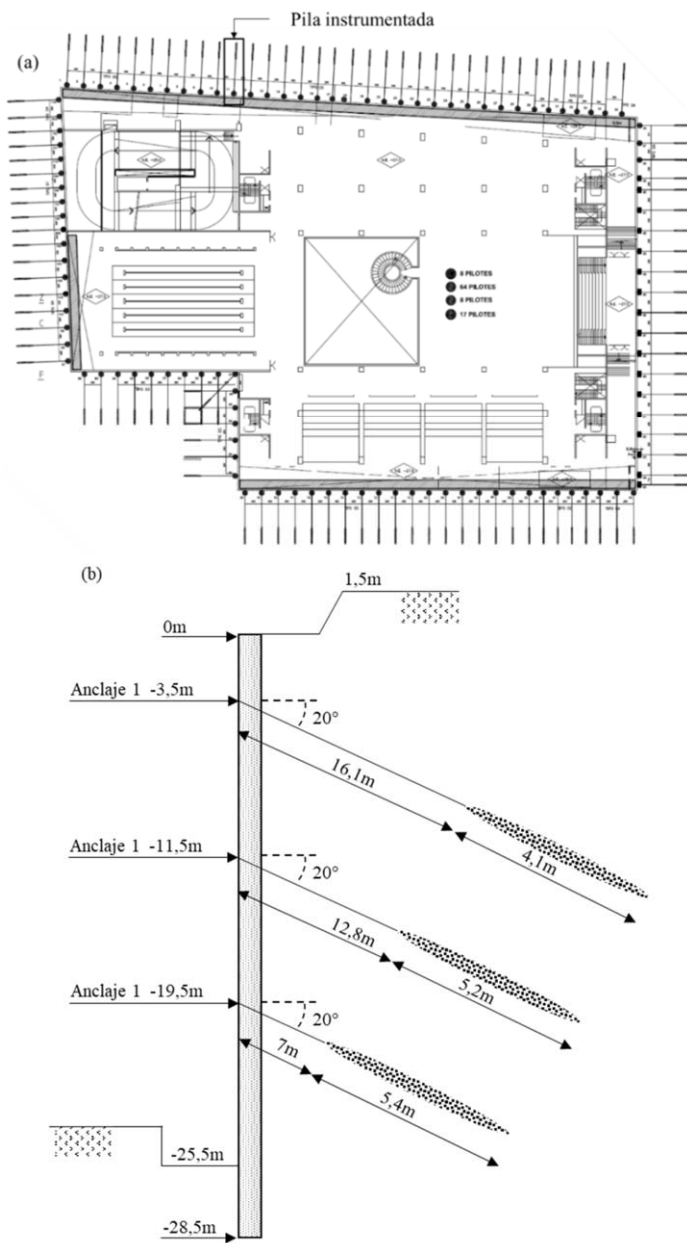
(a) Plano de Proyecto de excavación (b) Detalle de elevación de pila estudiada.
